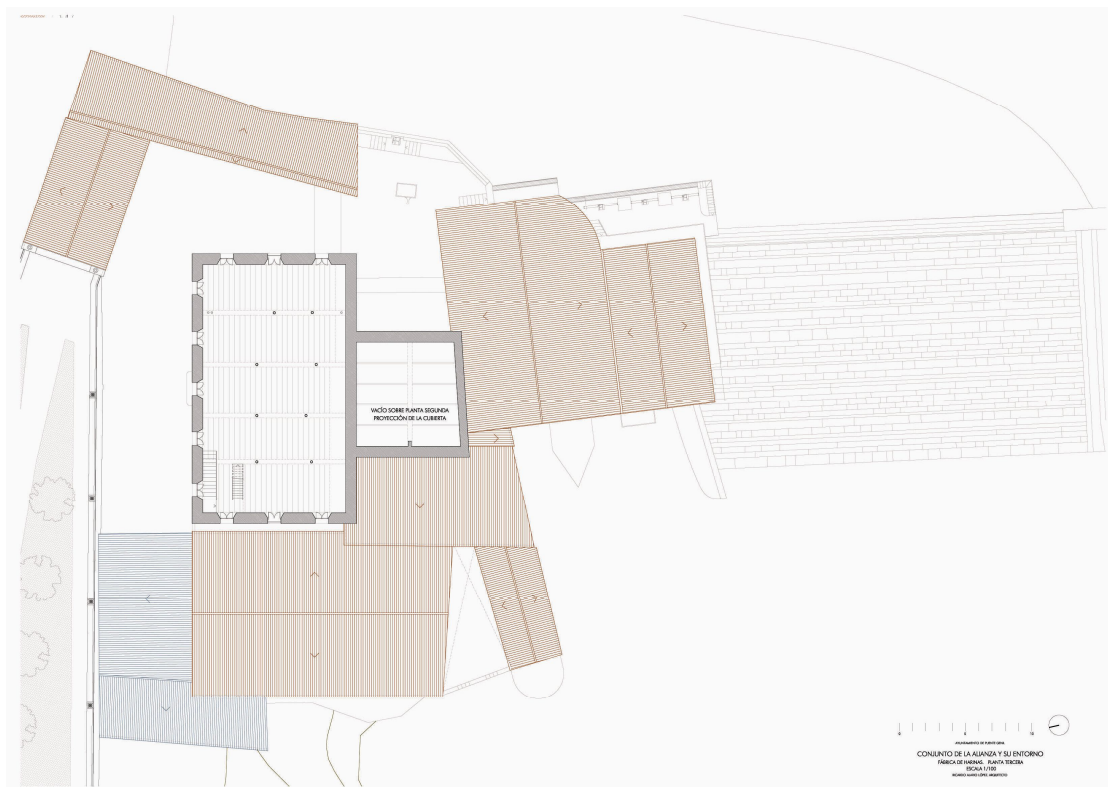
Conjunto de La Alianza y su entorno. Planta tercera. Escala 1/100. Fuente: Ricardo Alario López (arquitecto).
